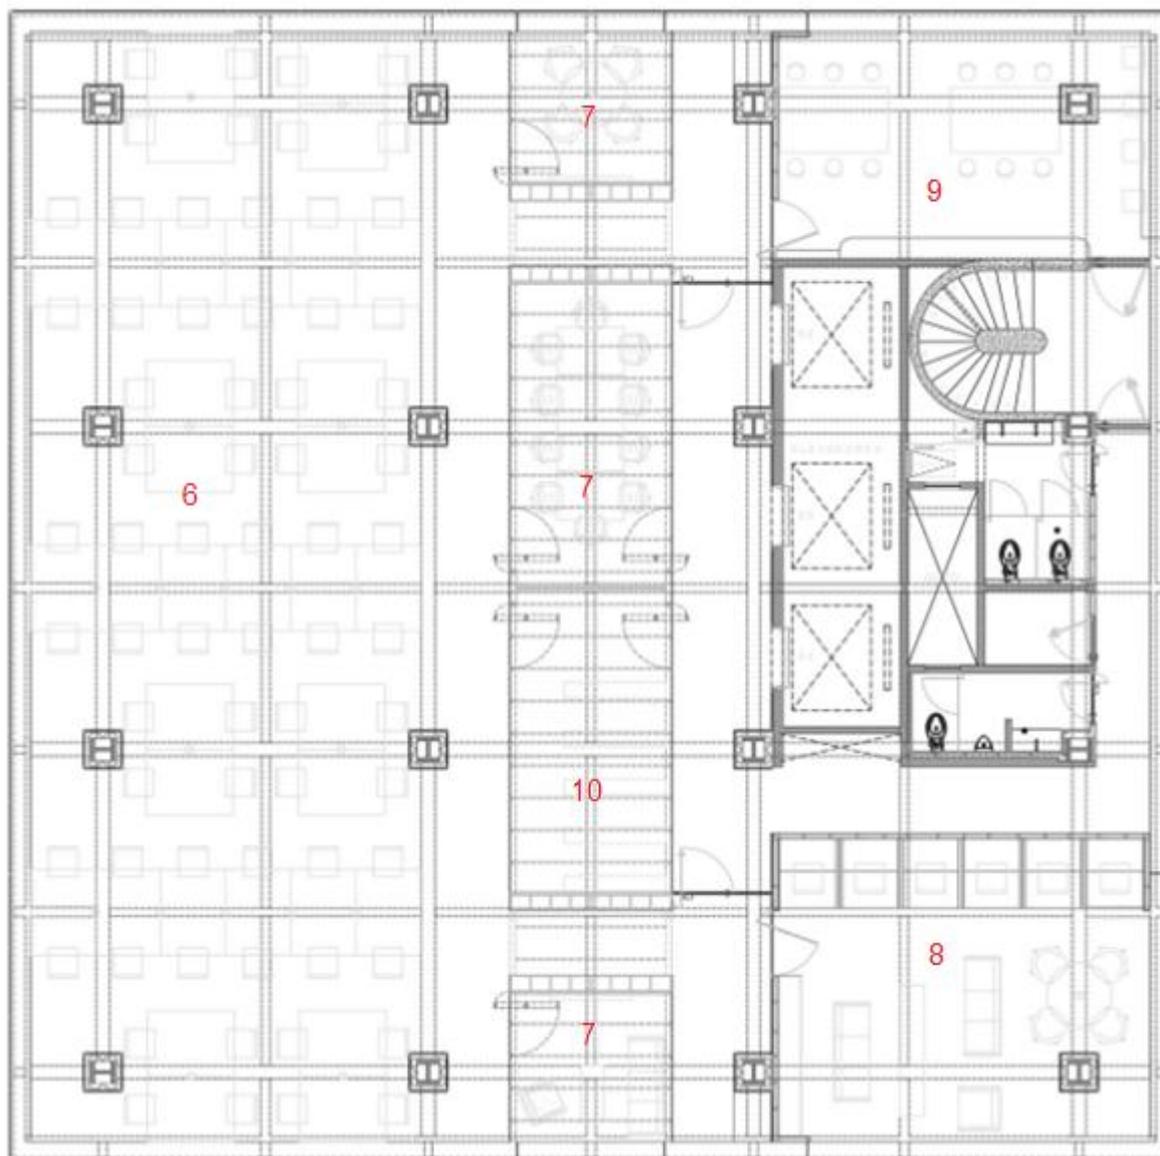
PLANTA DO SEGUNDO PAVIMENTO (29º ANDAR) DO ARCHIPIELAGO
